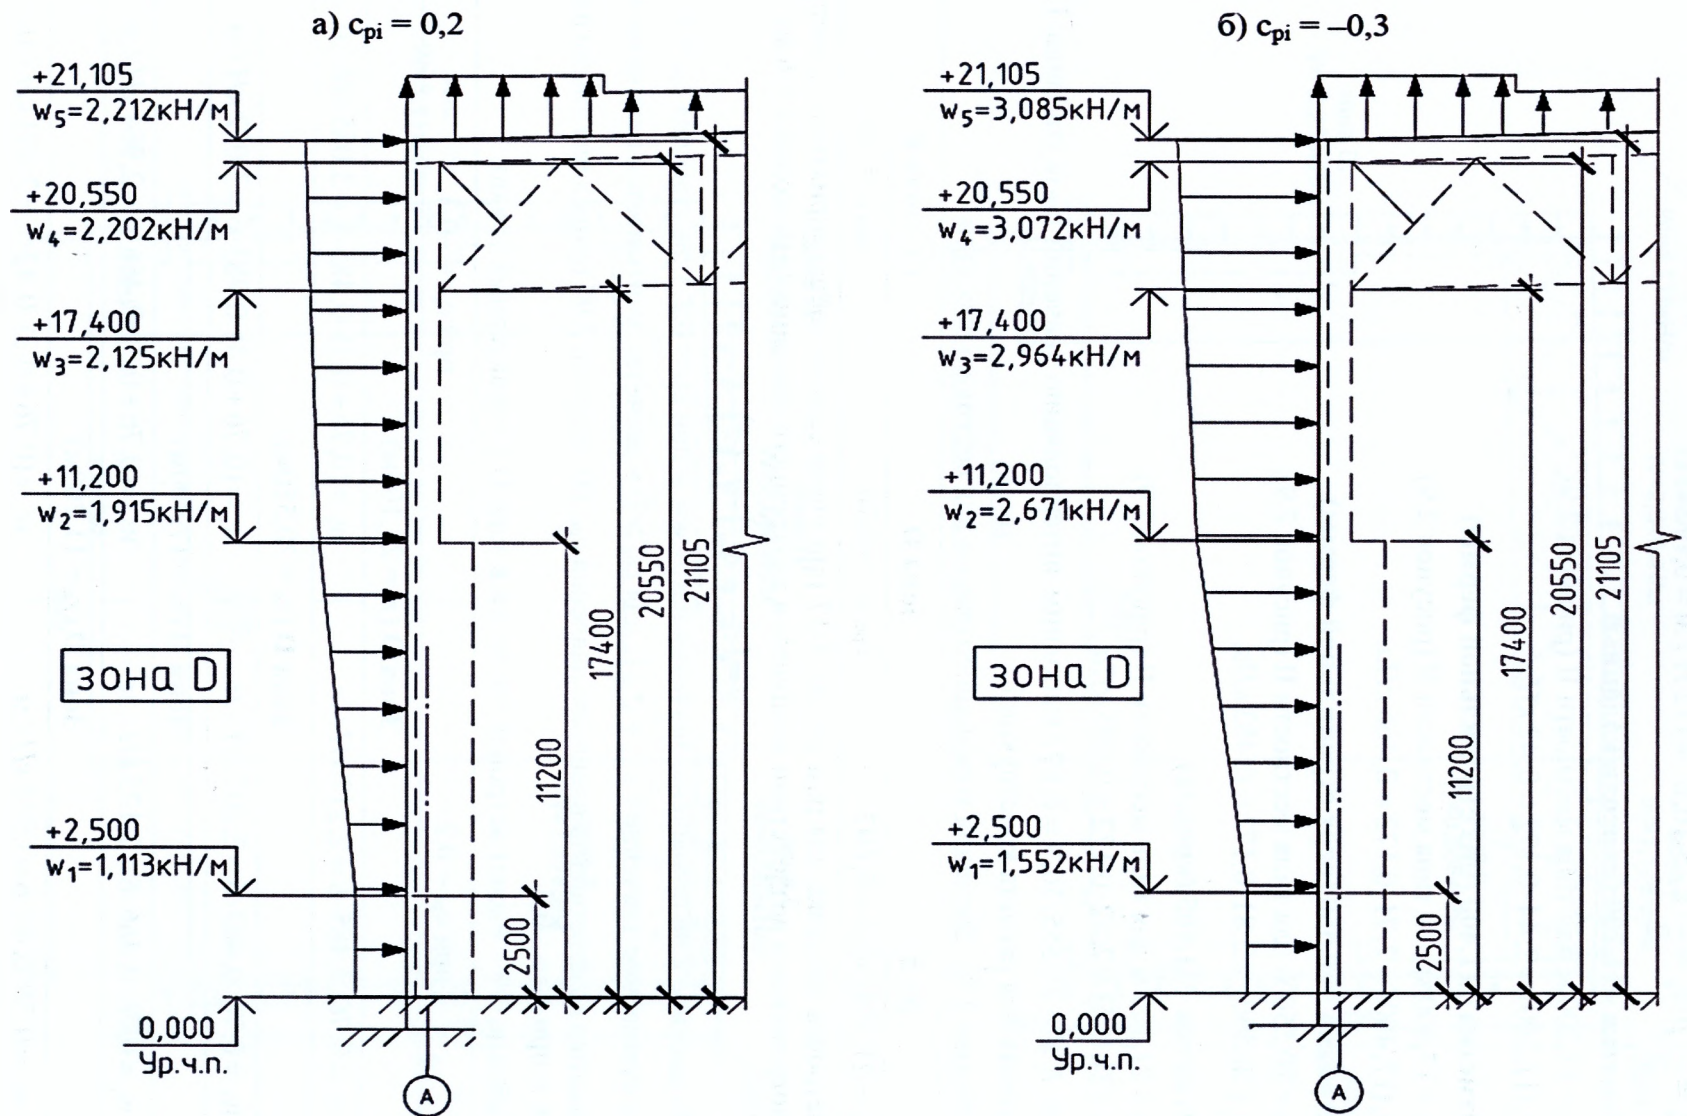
Распределение ветровой нагрузки для поперечной рамы в зоне D
